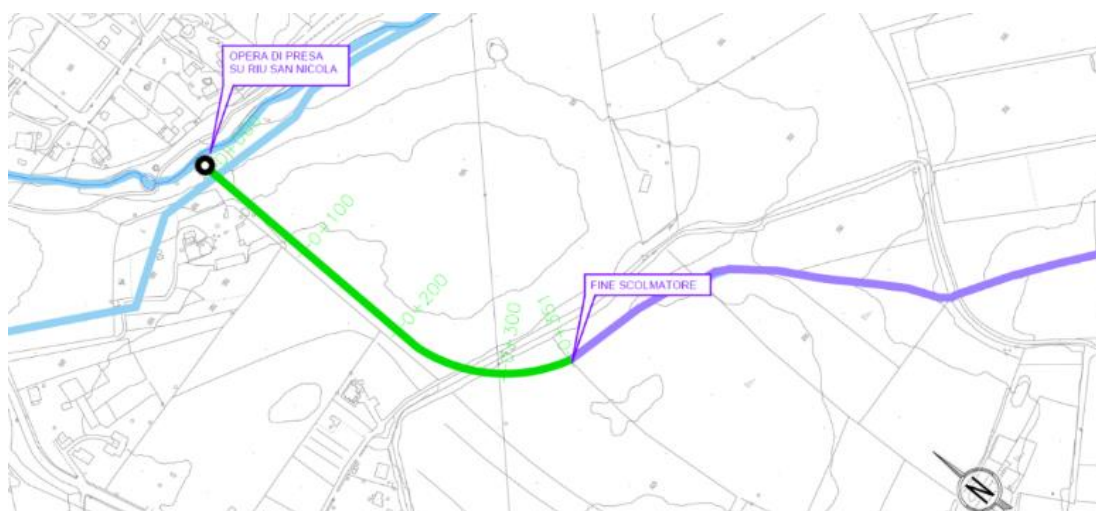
Planimetria dello scolmatore 3 “San Nicola – Zozò”
